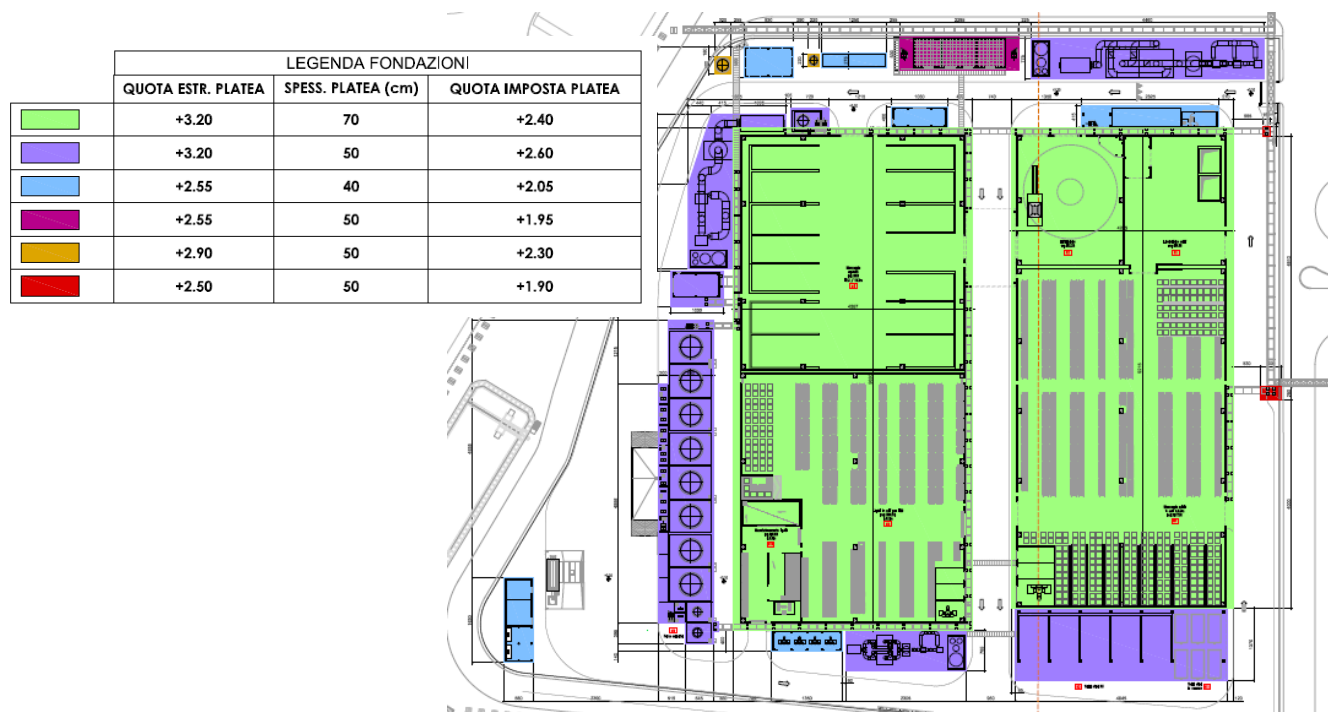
Stralcio planimetria fondazioni piattaforma polifunzionale HEA
